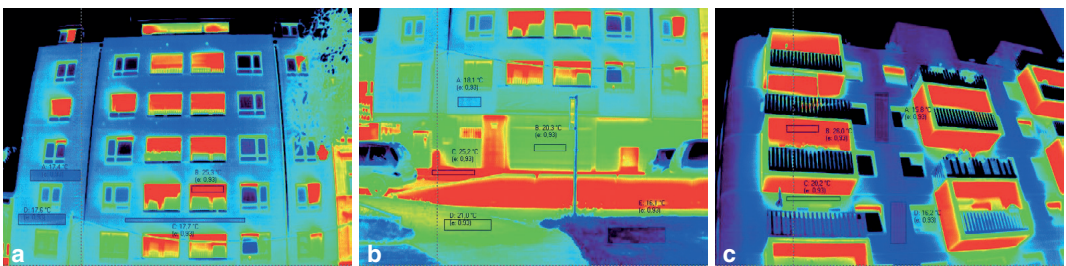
Thermografische Aufnahmen verschiedener Bauteile in der Aspangstraße, Wien, kurz vor Sonnenaufgang (rot: hohe, blau: niedrige Oberflächentemperaturen); a: Loggien im Fassadenbereich von Haus 29, b: Betonabsperren vor Haus 29, c: hervorstehende Betonkonstruktionen am Passivhaus 6 (oberer Fassadenbereich). – Fotos: TU Wien, 2018.
